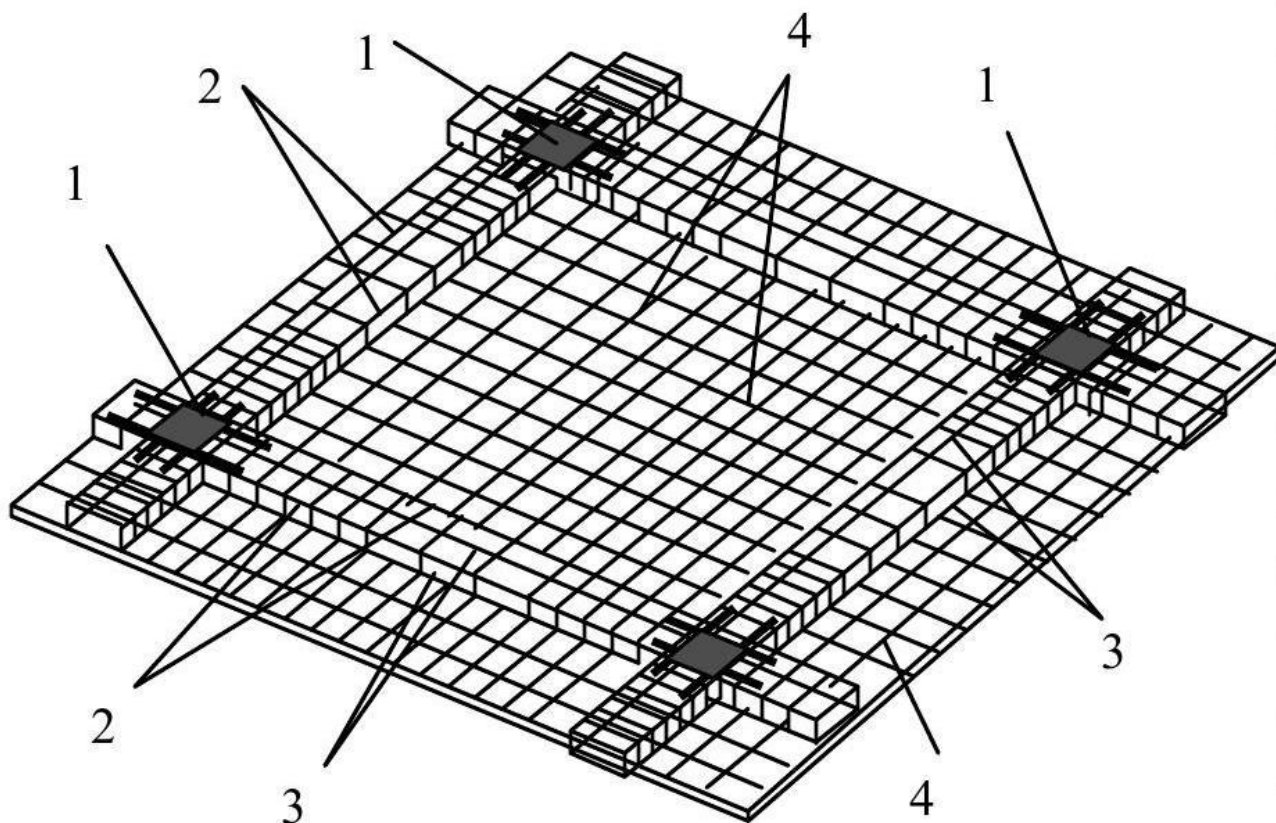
Схема безбалковими бескапительного перекриття з ригельним армуванням плити:
